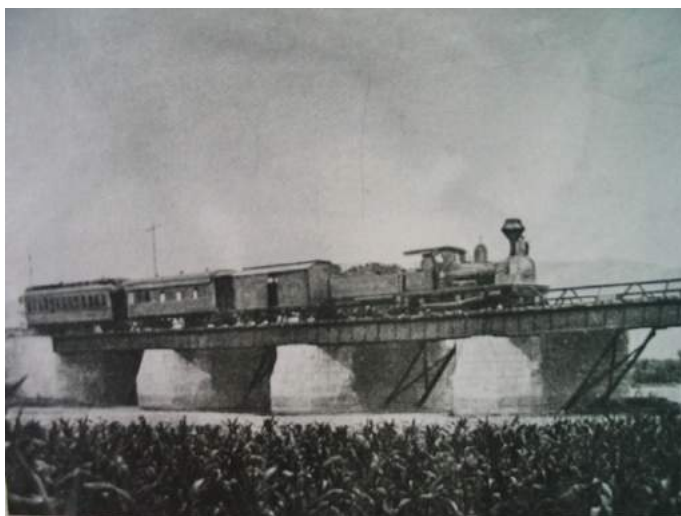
Puente Porfirio Díaz sobre el río Atoyac en el barrio San Juan Chapultepec era la salida hacia Zaachila. Consta de ocho pilas o apoyos con sus tajamares bien definidos, eran de cantería verde de la zona, actualmente la mayoría están reforzados con concreto y solo uno conserva su estructura íntegra; las vigas que componen la estructura de la calzada, como puede apreciarse, eran de acero desde su origen. Hoy al igual que el tren está en el olvido y se pierde en el entramado urbano. Fuente: Colección Foto Rivas, Av. Juárez No. 605 Oaxaca, Oax.
